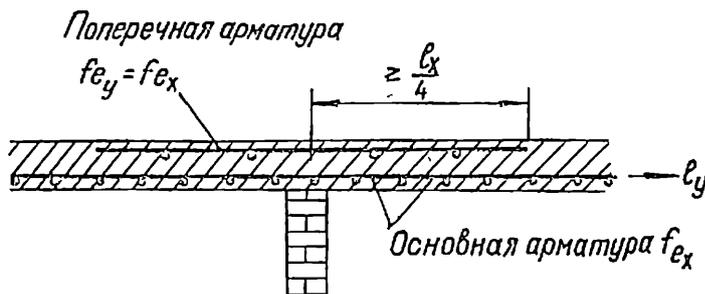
I - II. Поперечная арматура для неучтенных расчетом моментов на опоре m_y , например, над промежуточными стенами
